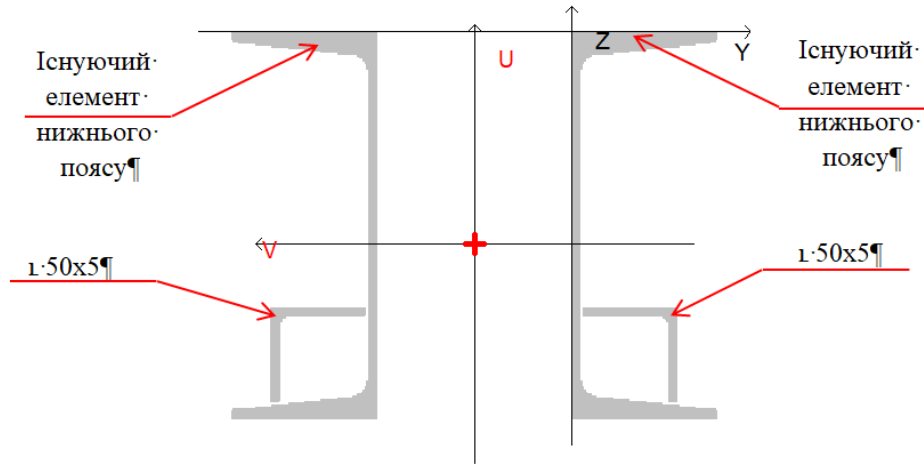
Схема перерізу підсилення елементів нижнього поясу ферми із зміщенням 15 см
